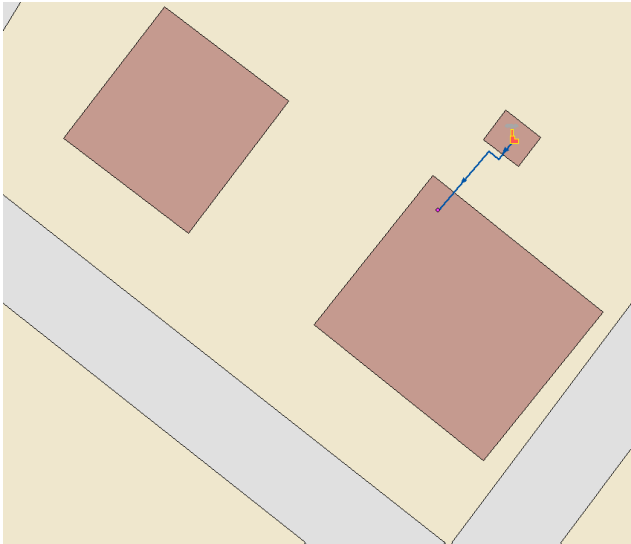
Схема тепловых сетей от здания котельной ул. Пирогова, дом №79а-1 (Роддом)
